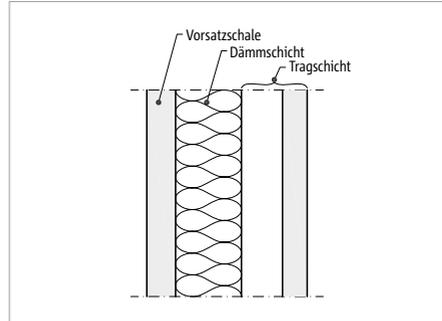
Schnitt durch eine Elementwand; Tragschicht mit Ortbetongängzung
